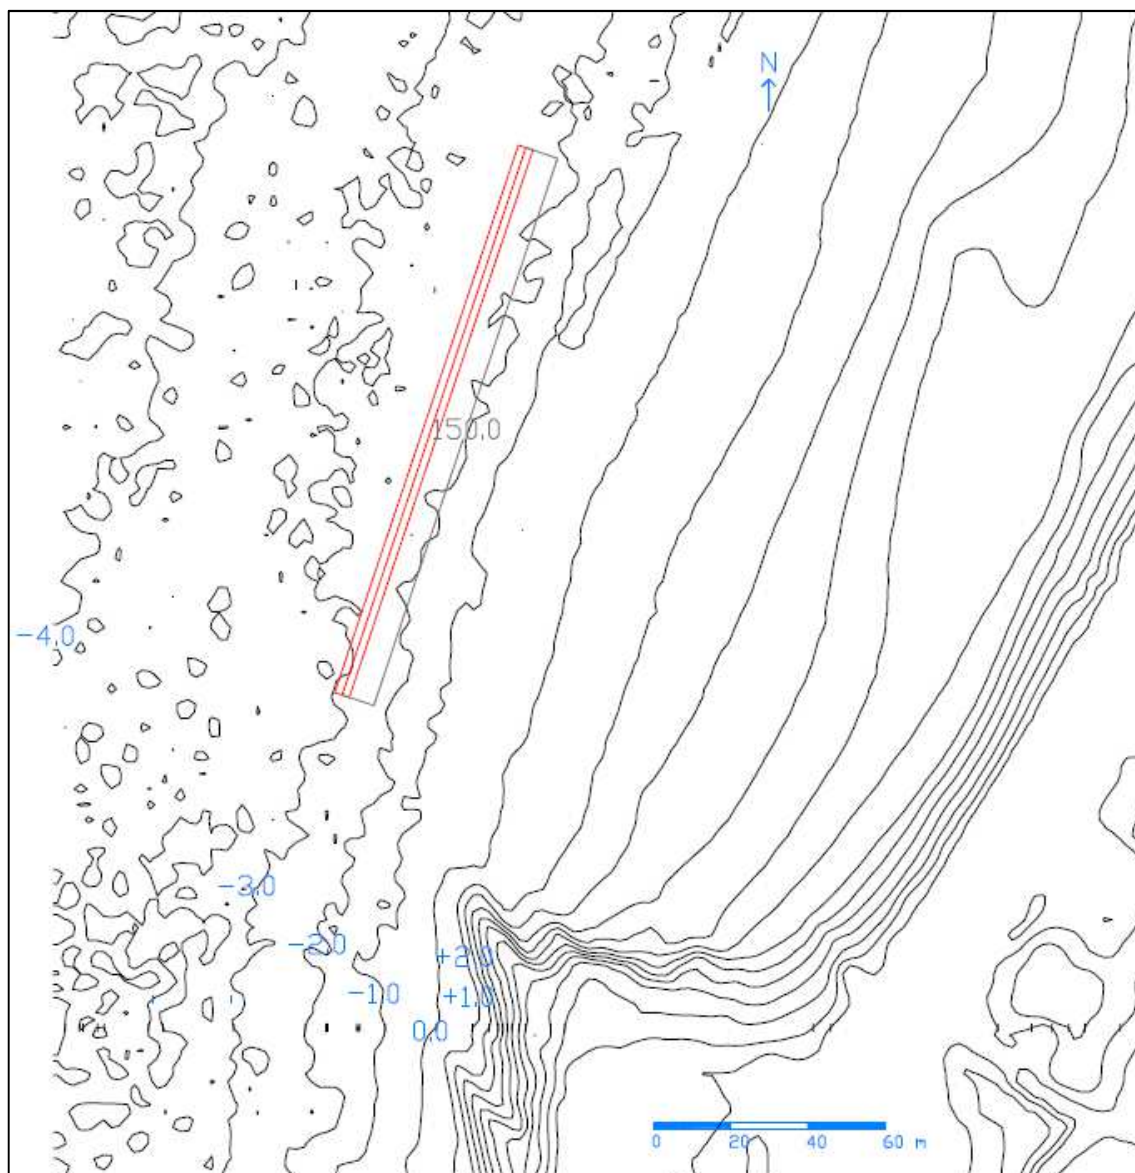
Planta de implantação de quebramar destacado contínuo com 150 m de comprimento
